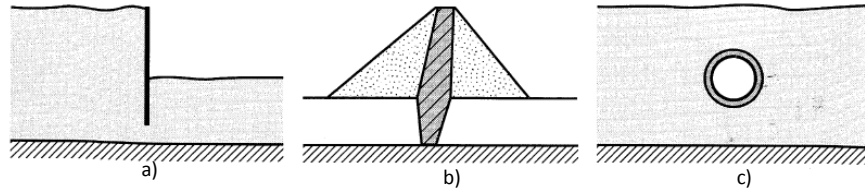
Ejemplos de algunas estructuras analizadas bidimensionalmente. a) muro de retención en cantiléver; b) presa de tierra; c) túnel.
